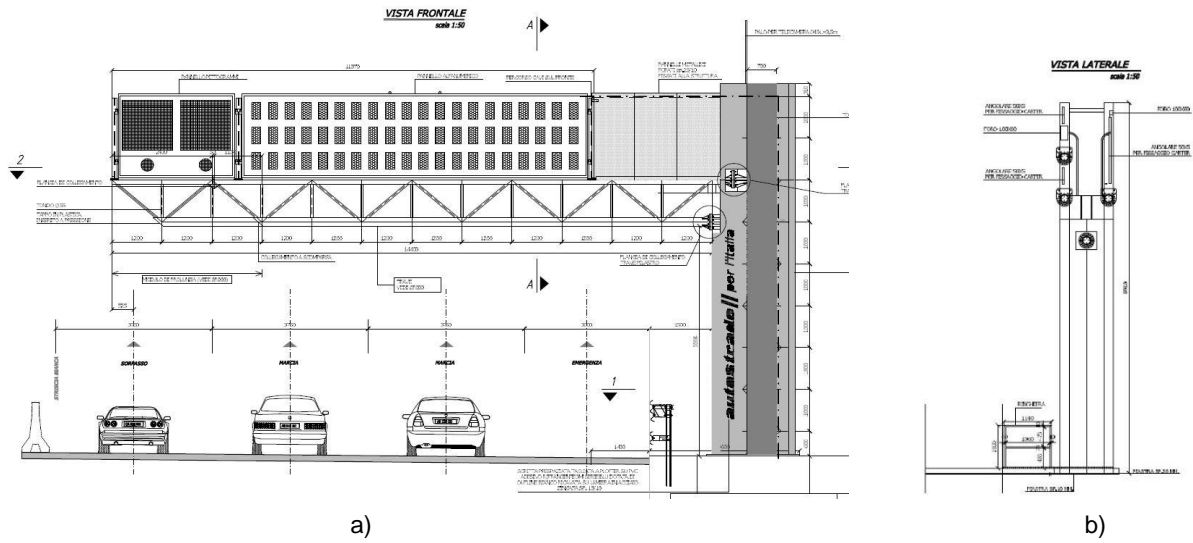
Portale a messaggio variabile a bandiera – itiner: prospetto frontale a); prospetto laterale b)
